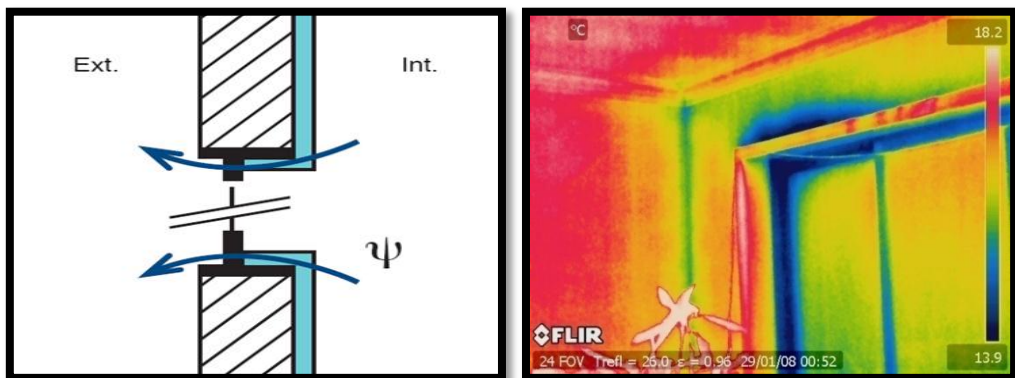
Ligação da Fachada/Ombreira, Padieira ou Peitoril; fonte: RCCTE (2006); Finn M. (2004)
